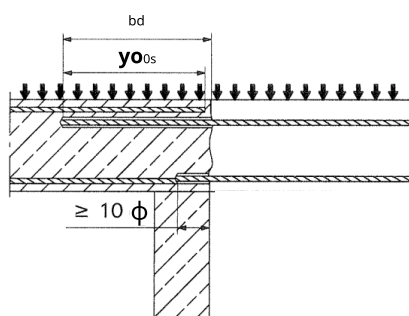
junta superpuesta en los cimientos de una pared o columna donde las barras de refuerzo están sometidas a tensión.
